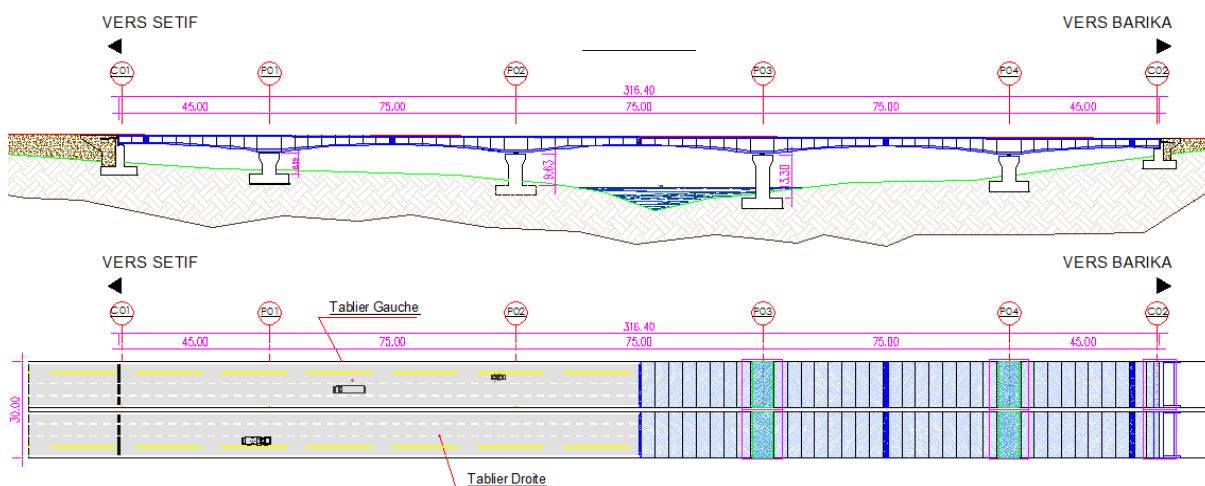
Coupe longitudinale et vue en plan de la Variante 2
